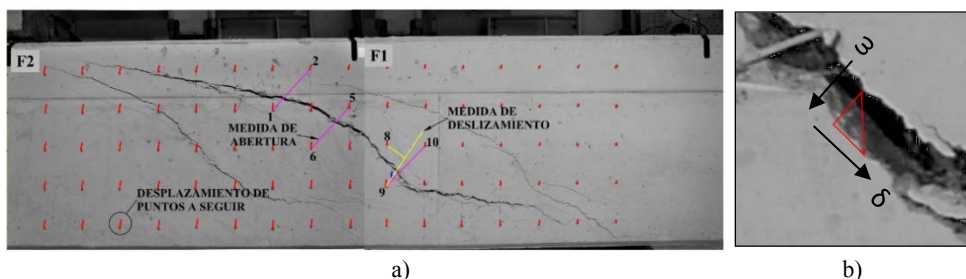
a) Medición entre puntos de seguimiento en fotografías posición F1 y F2 de viga 0AP1, b) Abertura y deslizamiento a carga máxima de fisura diagonal principal viga 0AP1
